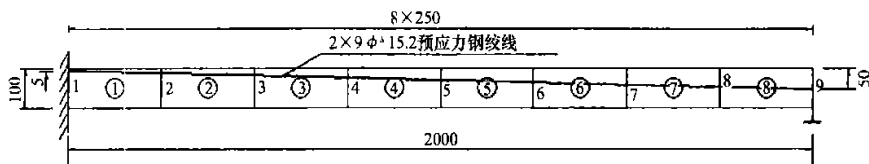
预应力混凝土超静定结构单元离散及钢束布置示意图/cm
